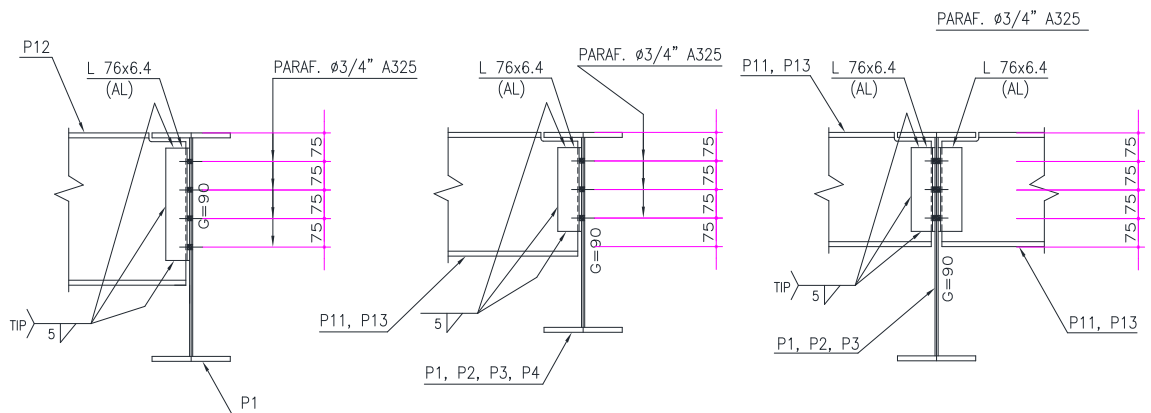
Detalhe típico de ligações parafusadas entre vigas do edifício. (Fonte: Projemax Projetos Industriais)
